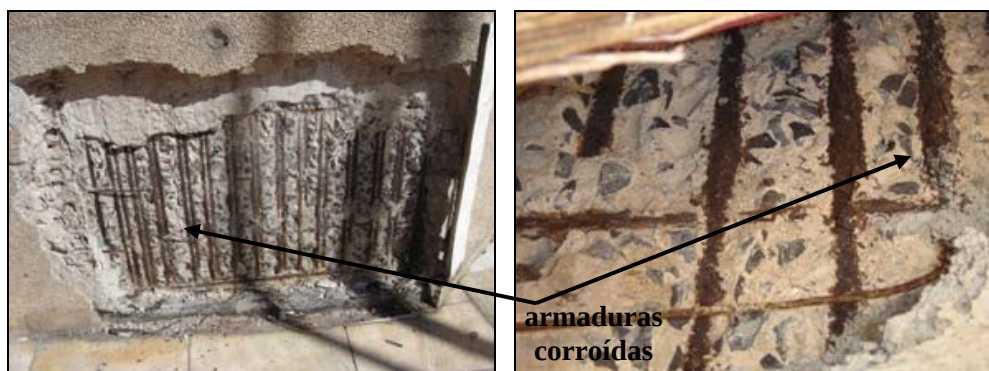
Destacamentos e fissuras nos pilares P3 e P13 no pavimento térreo (Edifício 1)
